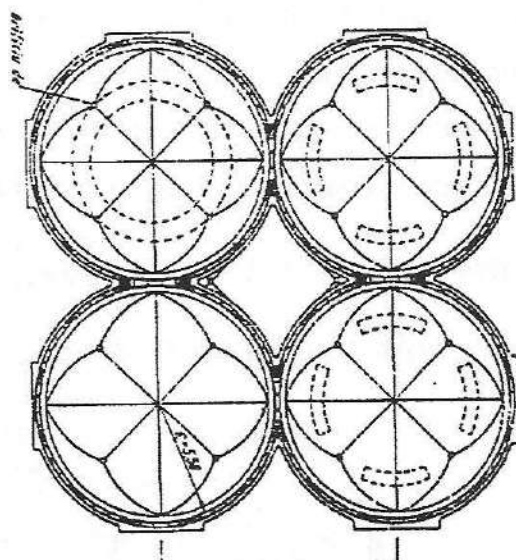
Plan amplasare celule siloz, realizat din beton armat precomprimat.
